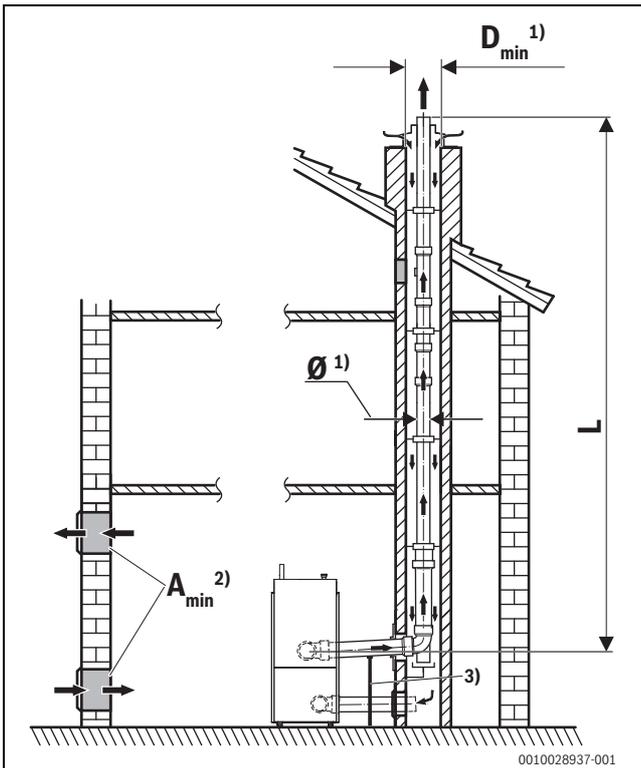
Wirksame Höhe der Abgasleitung, im Schacht, Variante 1
